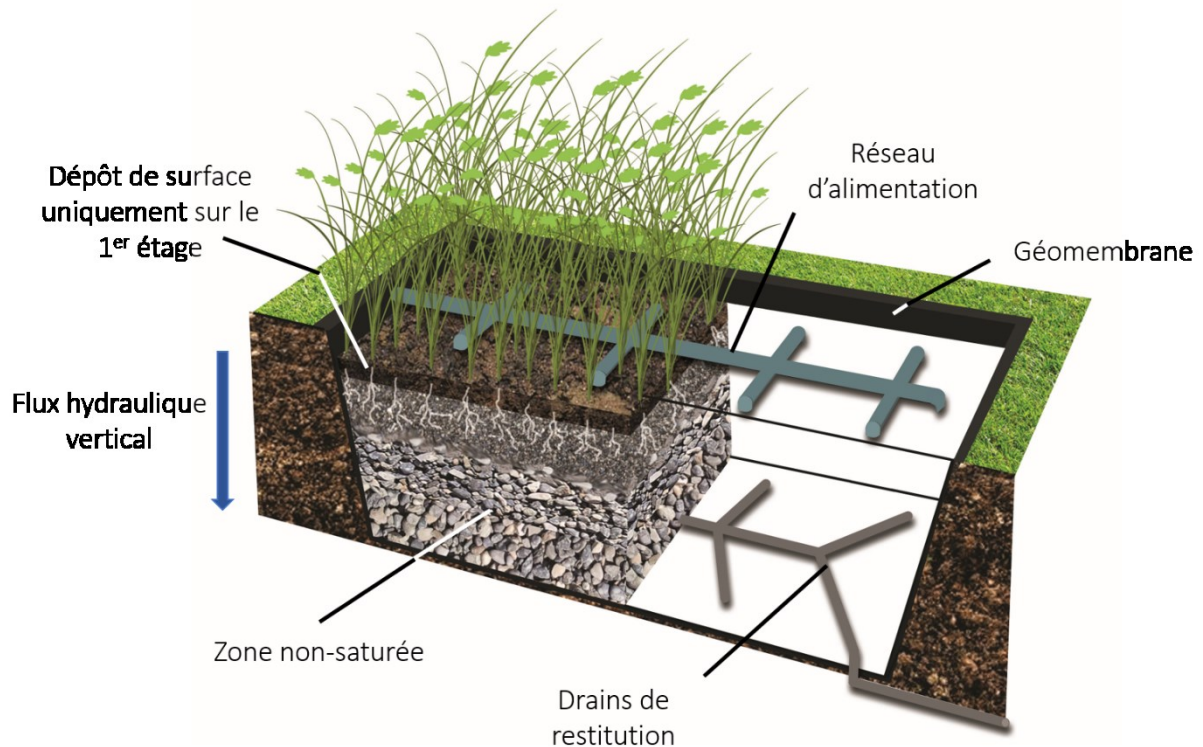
SCHEMA D'UN FILTRE PLANTE DE ROSEAUX A ECOULEMENT HYDRAULIQUE VERTICAL. (CREDITS SCHEMA : E. BON)
